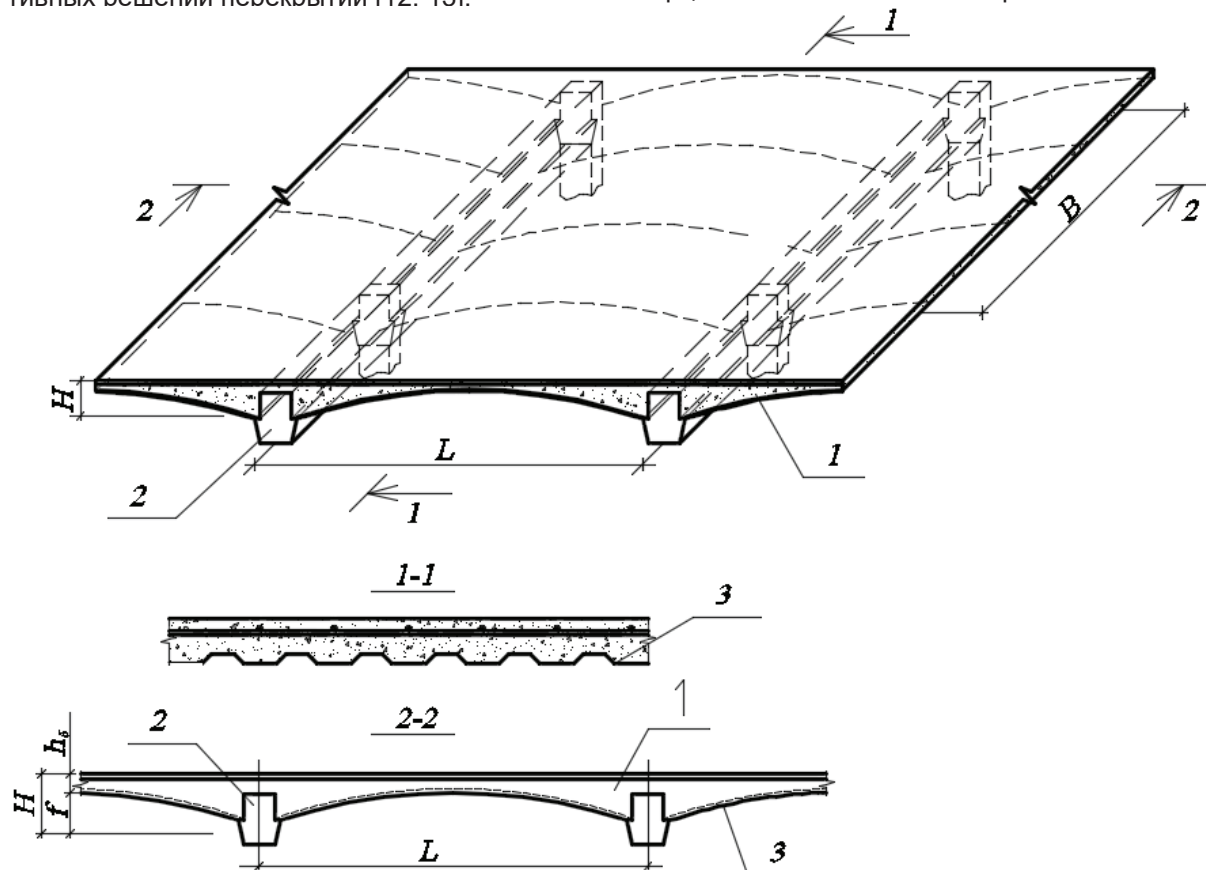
Фрагмент монолитного перекрытия подземного перехода с нижней сводчатой поверхностью:
